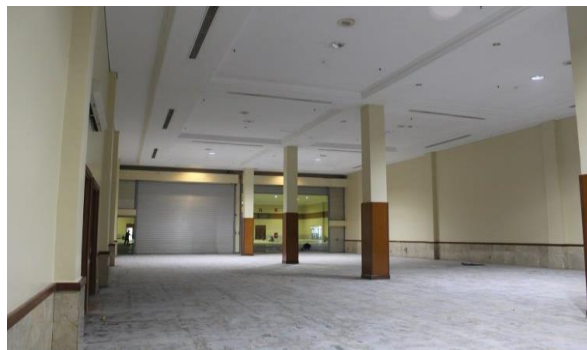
Plenary Hall* Lantai 1 JCC
